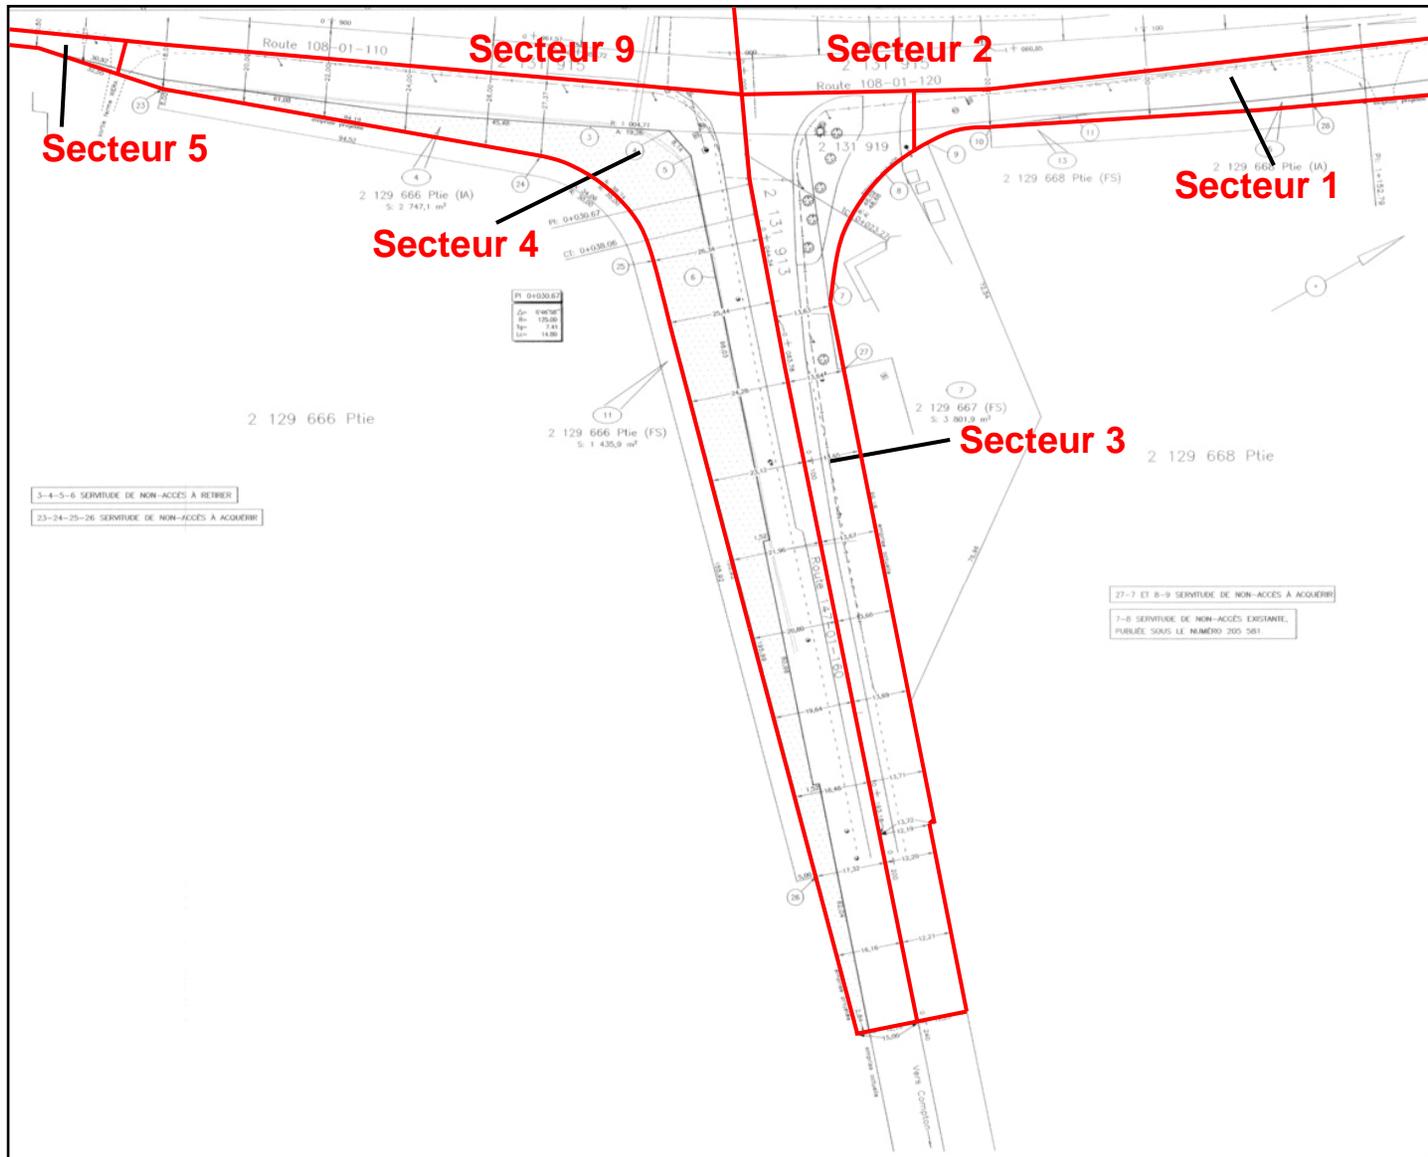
Localisation des secteurs 1, 2, 3, 4, 5, 9, projet n° 154-02-1762 (source : Ministère des Transports, plan d'ensemble [extrait], Plan d'ensemble, plan CH-9007-154-07-1785, 15 mars 2010)
